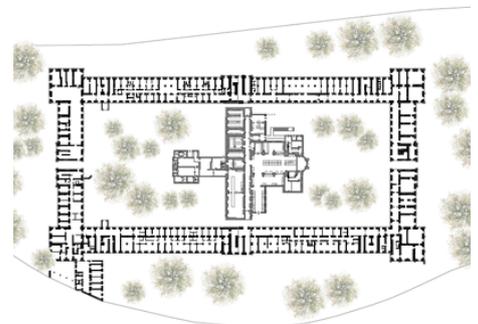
Grundriss Psychiatrisches Krankenhaus
